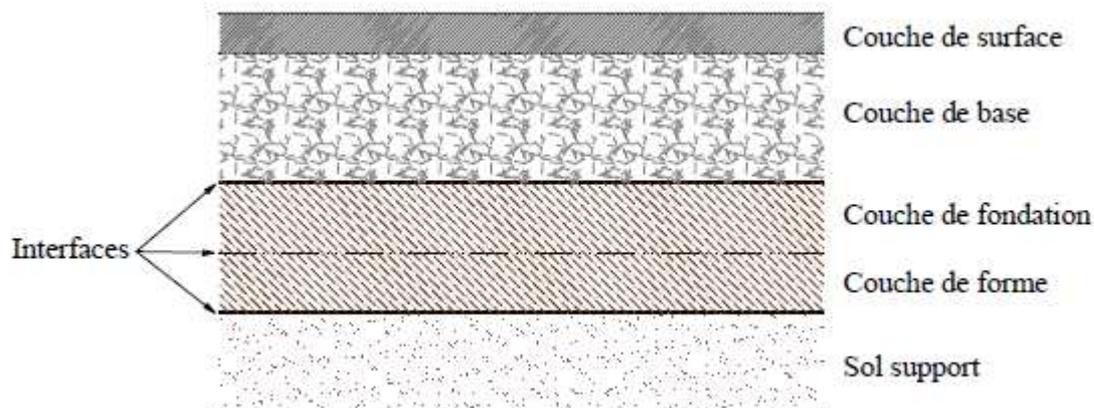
Différentes couches constitutives de la chaussée à structure réservoir1
